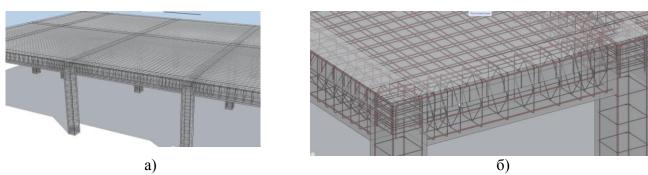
Армирование железобетонного каркаса (Примечание: а) армирование колонны, плиты, балки; б) узел армирования колонны с балкой)
